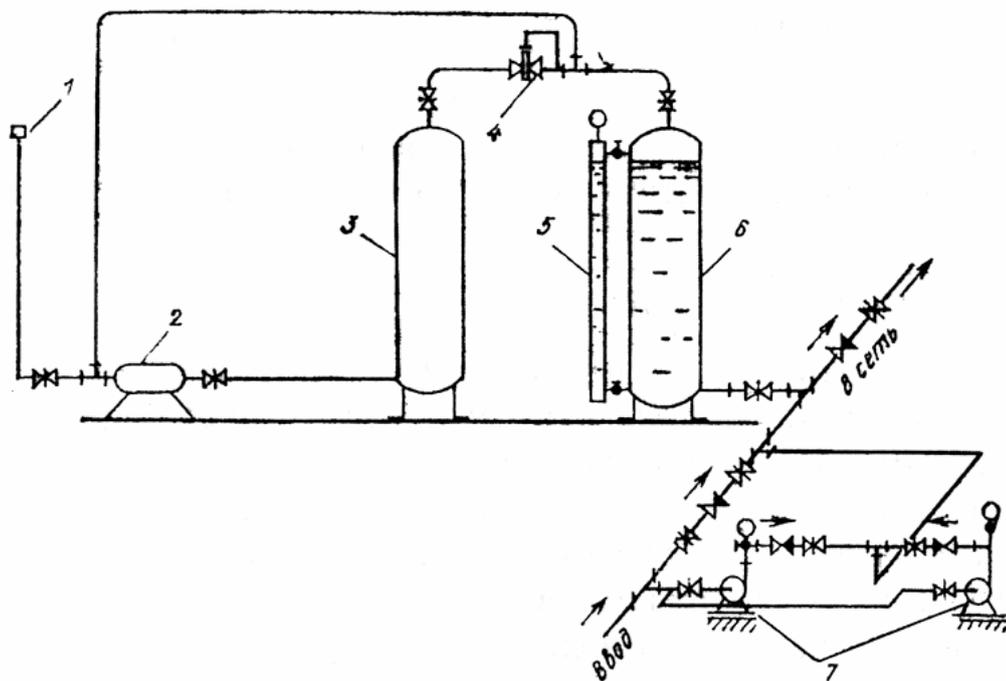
Схема пневматической установки низкого давления: 1 – фильтр; 2 – компрессор; 3 – воздушный резервуар (котел); 4 – редукционный клапан (регулятор давления); 5 – указатель уровня; 6 – водяной резервуар; 7 – насосы
